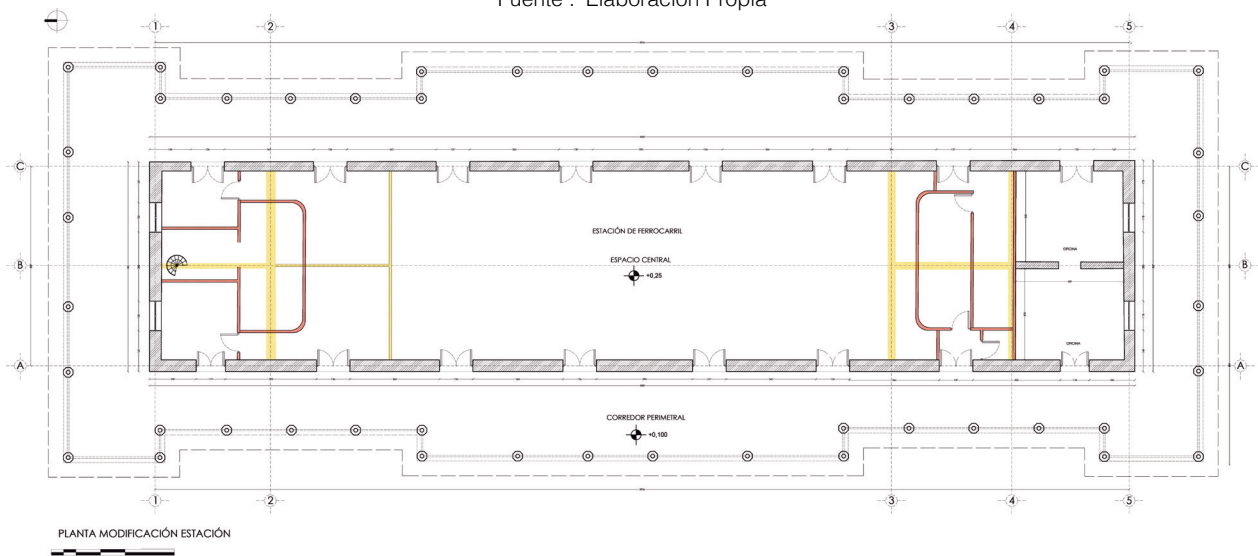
Planimetría de Intervención Situación Actual (Rojo Construcción, Amarillo, Demolición)
